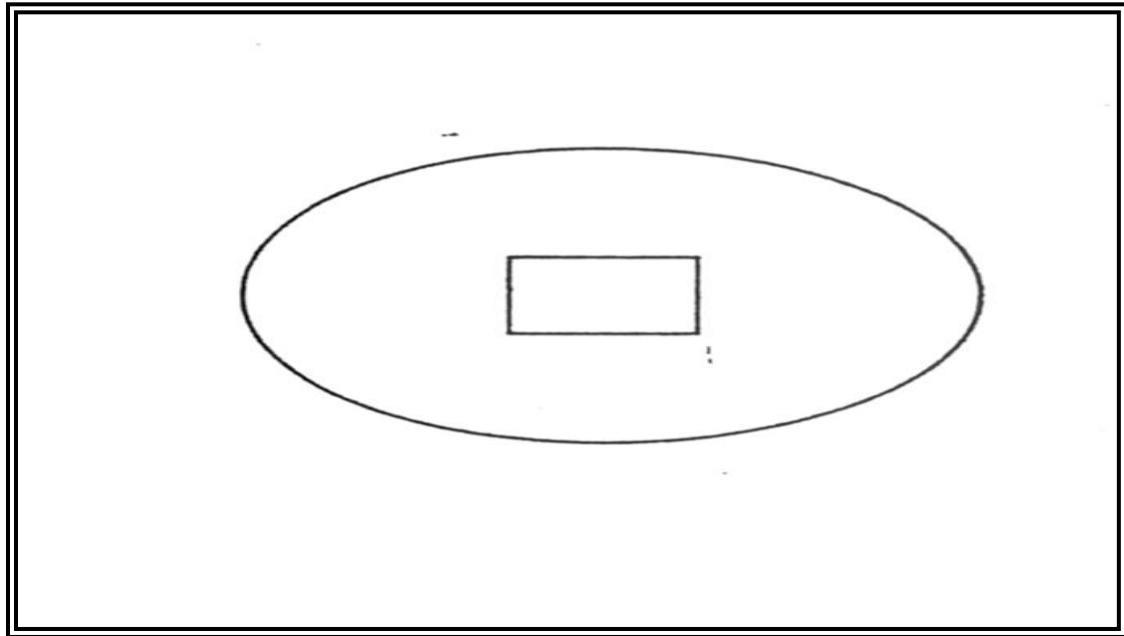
مسقط أفقي لجزء من قناة عين وادي قوز
